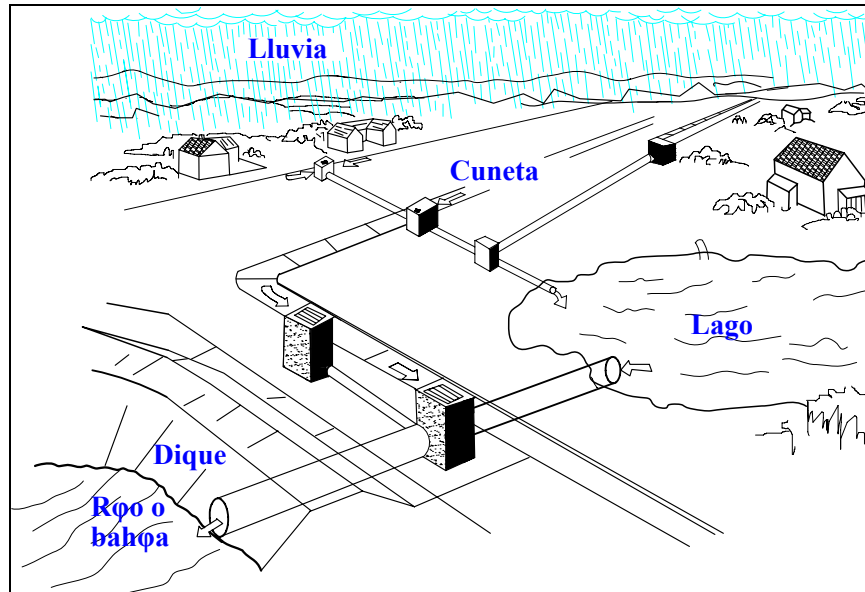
Sistema de alcantarillado pluvial (ASCE, 1992).
